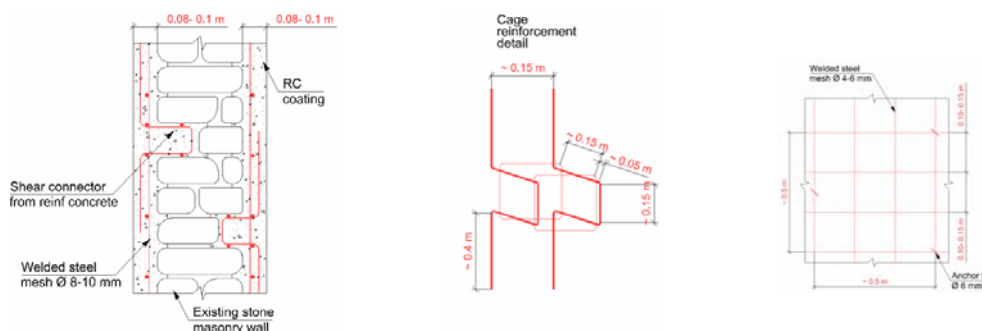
Pormenor da conexão da parede de alvenaria de pedra com a lâmina de betão
